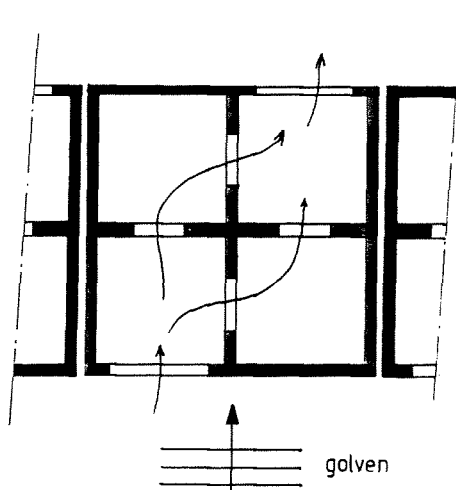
Betonnen elementen (horizontale doorsnede).
